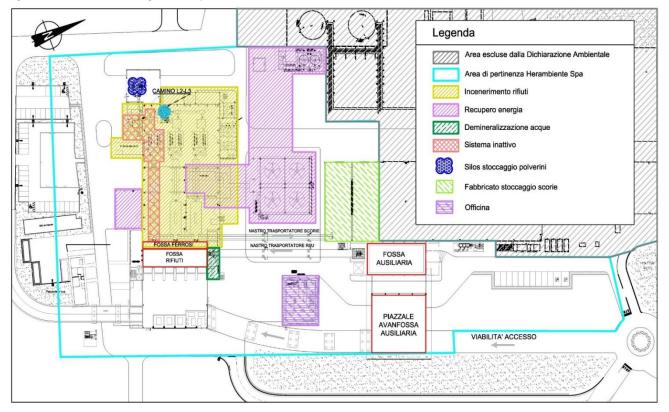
Planimetria di dettaglio dell'impianto di termovalorizzazione
